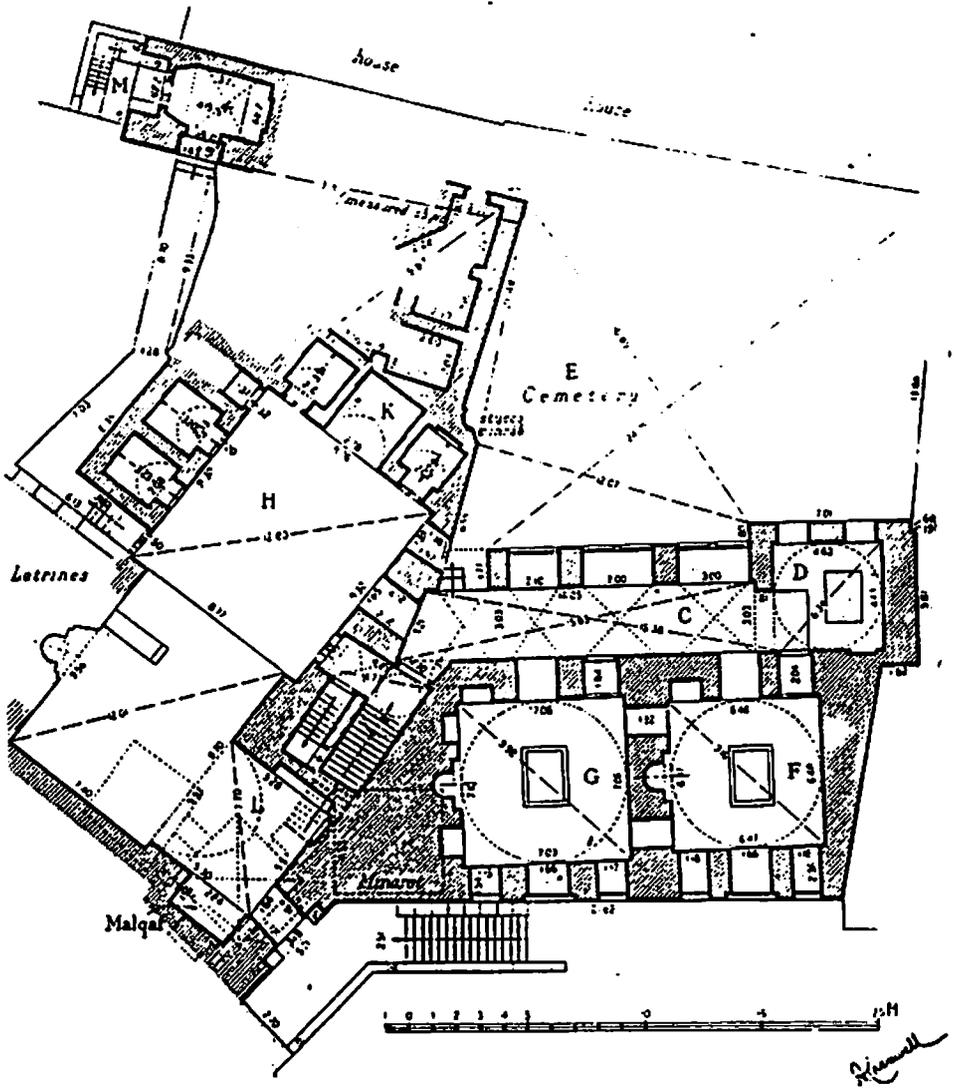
مسقط أفقى لمدرسة وقبة زين الدين يوسف عن محاضر لجنة
